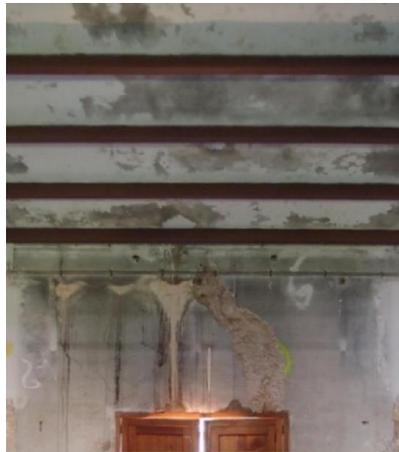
Vista frontal del apoyo de la cercha sobre la pilastra de marés.
